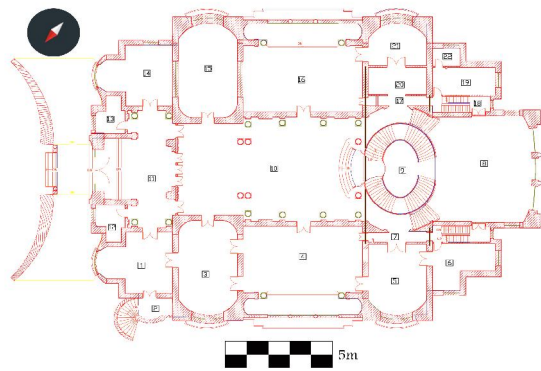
مسقط أفقي لسطح القصر (عمل الباحث)
